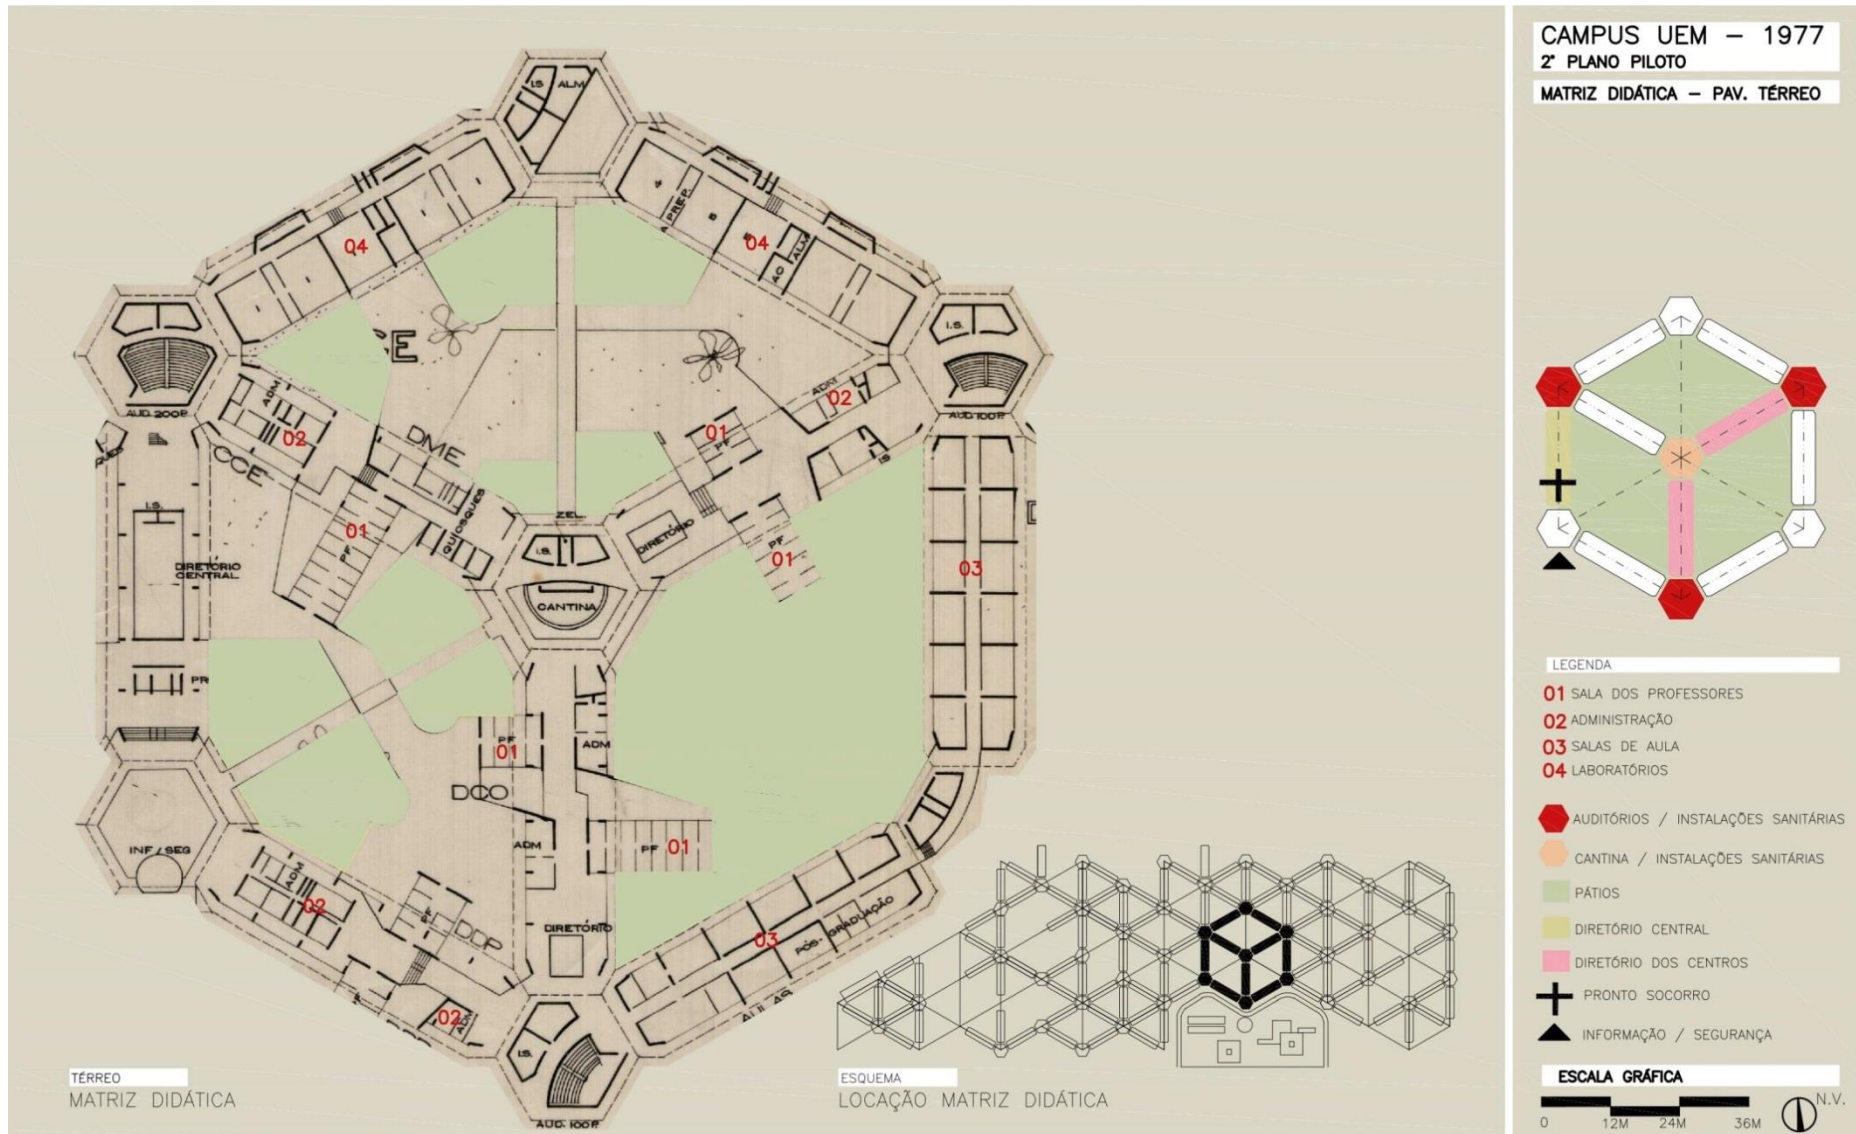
Matriz Didática Pavimento Térreo. Fonte: Mapa Base Prancha 08 – Plano Piloto 1977. Disponível na DOP/PTO. Elaboração Renan Avanci.
